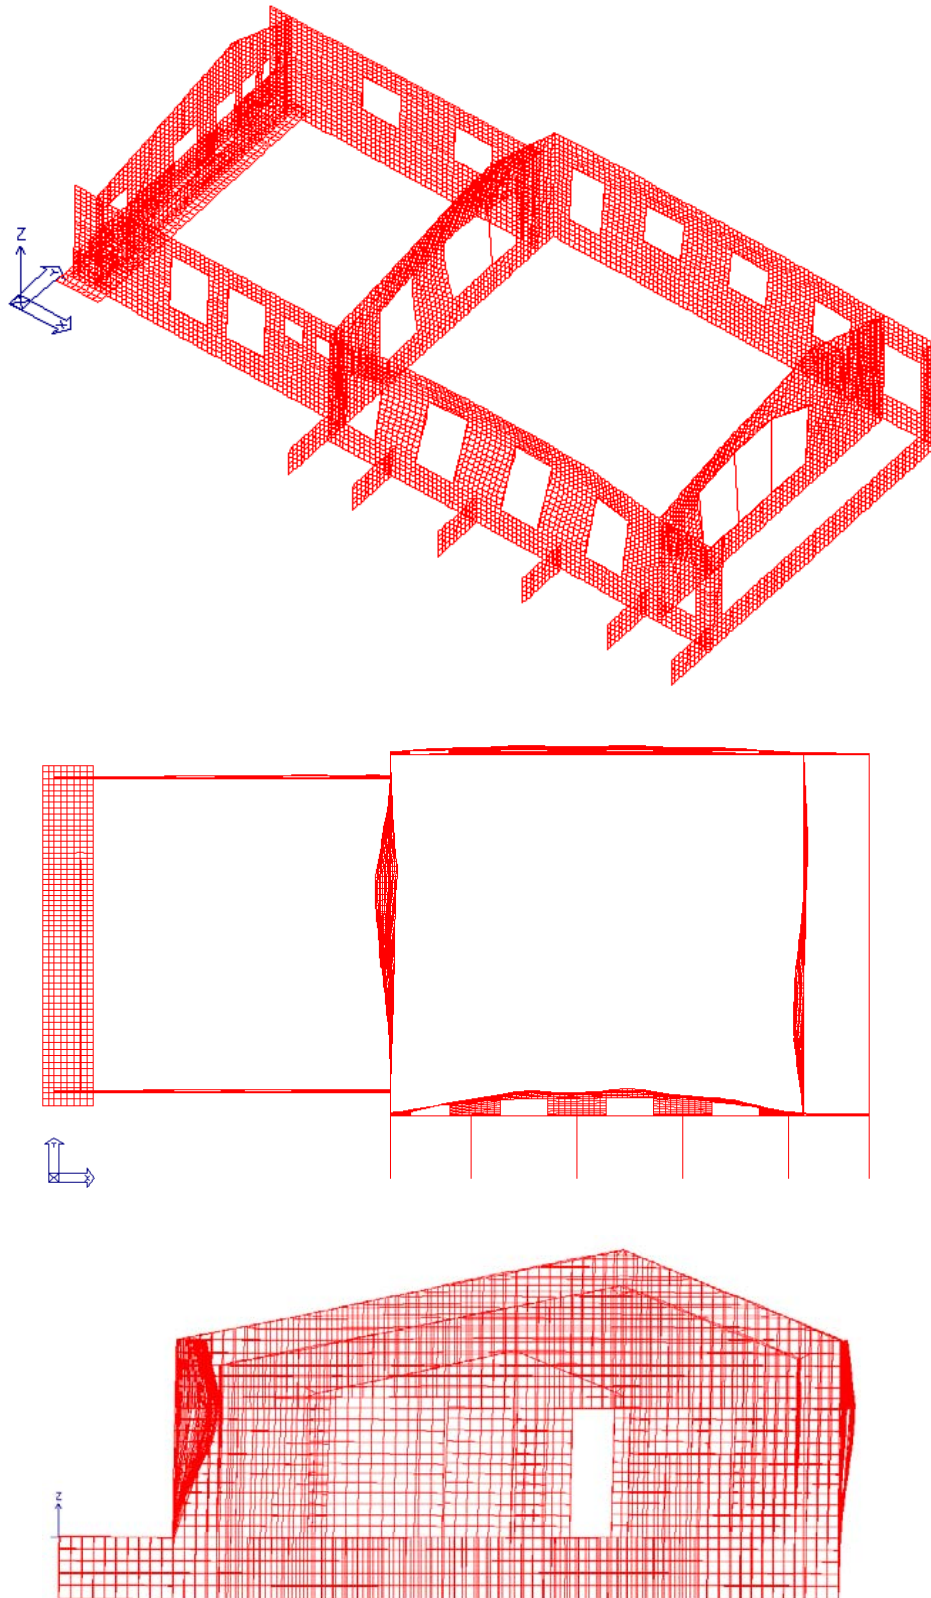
Modo di vibrare principale n. 5 dir. y-y – vista assonometrica, vista in pianta e vista frontale piano Y-Z.
